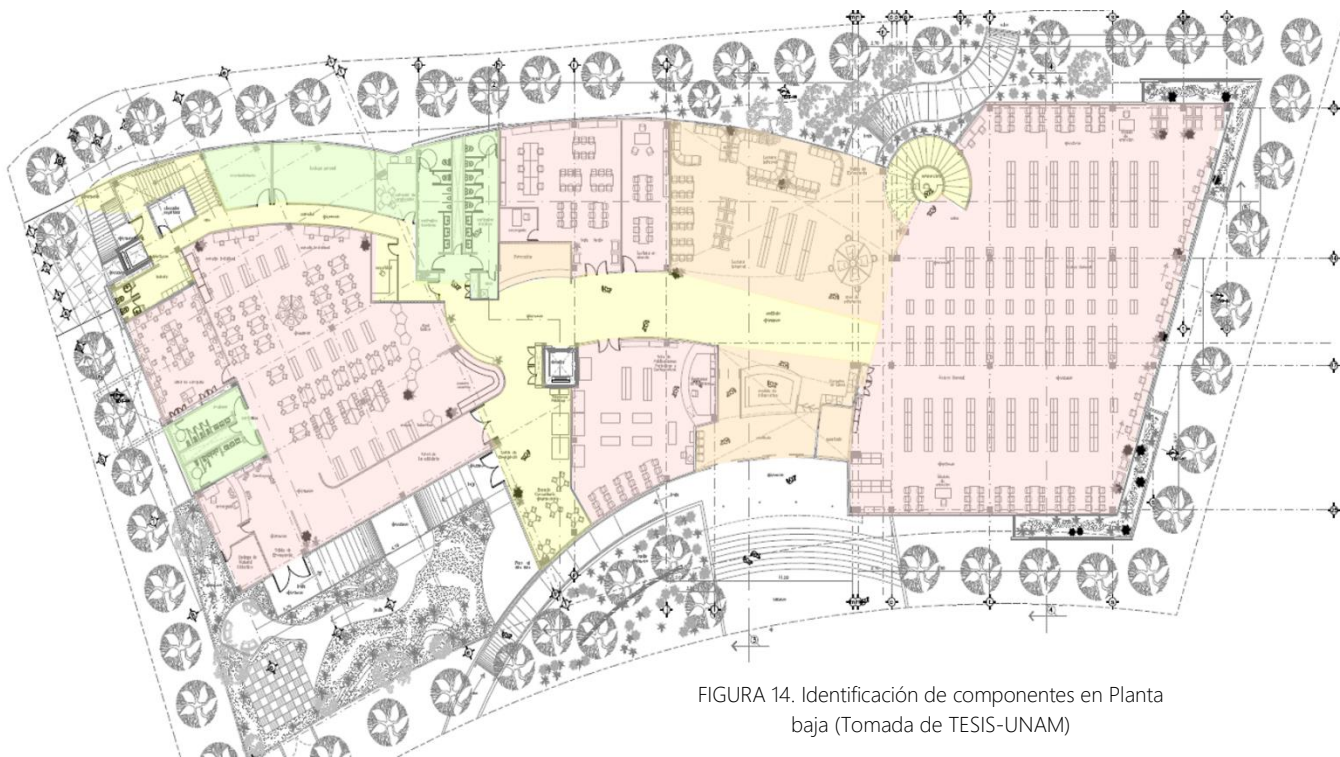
Identificación de componentes en Planta baja (Tomada de TESIS-UNAM)
